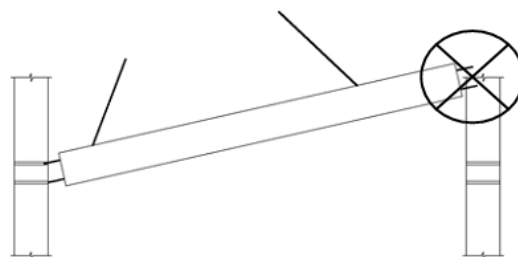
Detalhe de ligação a evitar (ALBARRAN, 2008).
